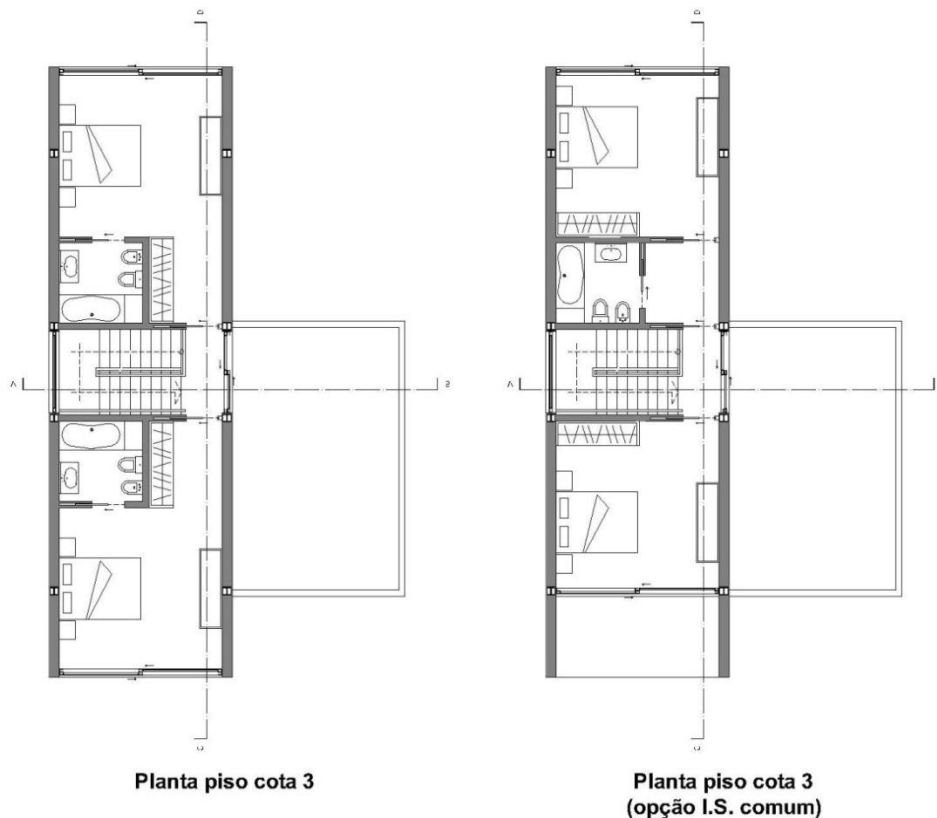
Planta piso cota 3 com opção (3ª fase)
